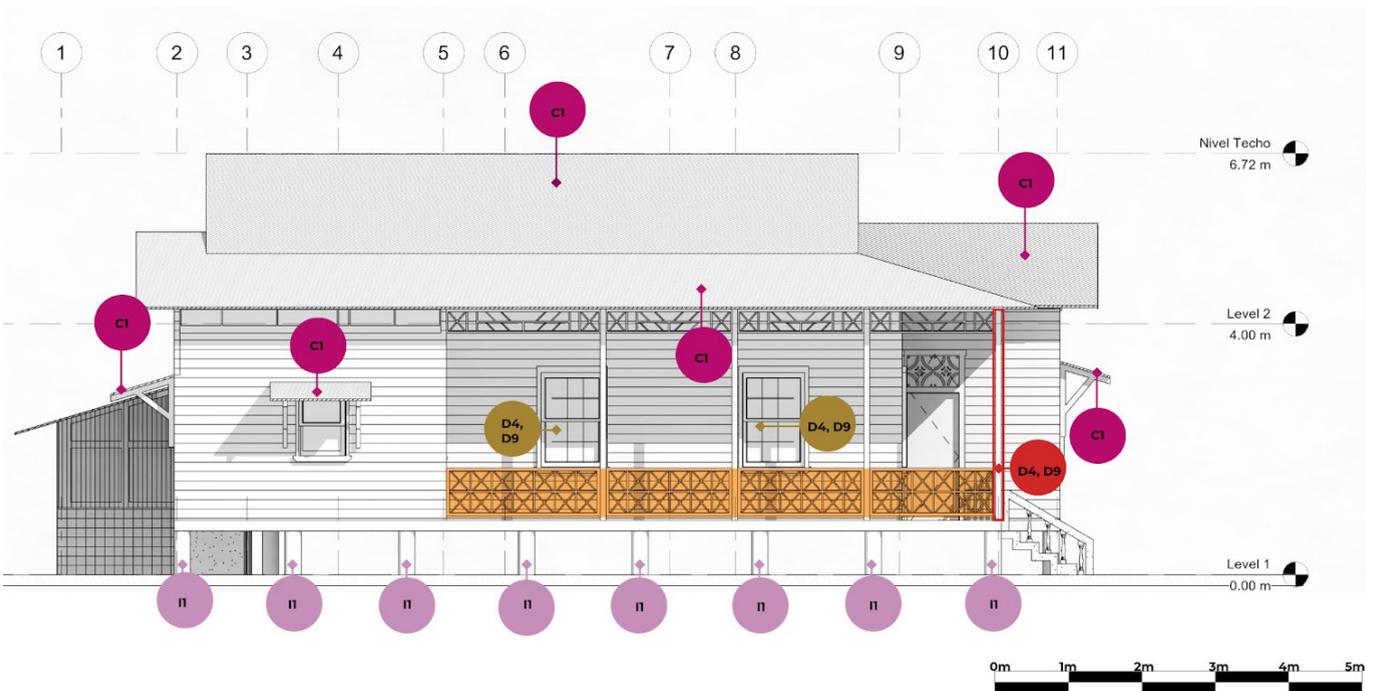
Planos de lesiones. Vivienda unifamiliar aislada (M-Tipo 1-01). Elevación lateral. Fuente: Garay (2021).
